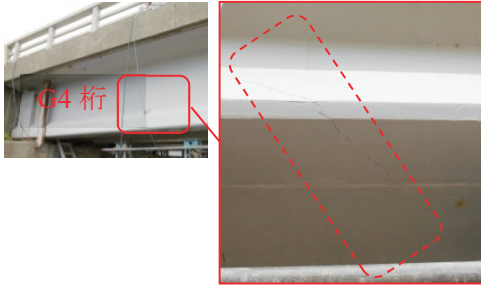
ねじりによるひび割れ (G4 桁)
